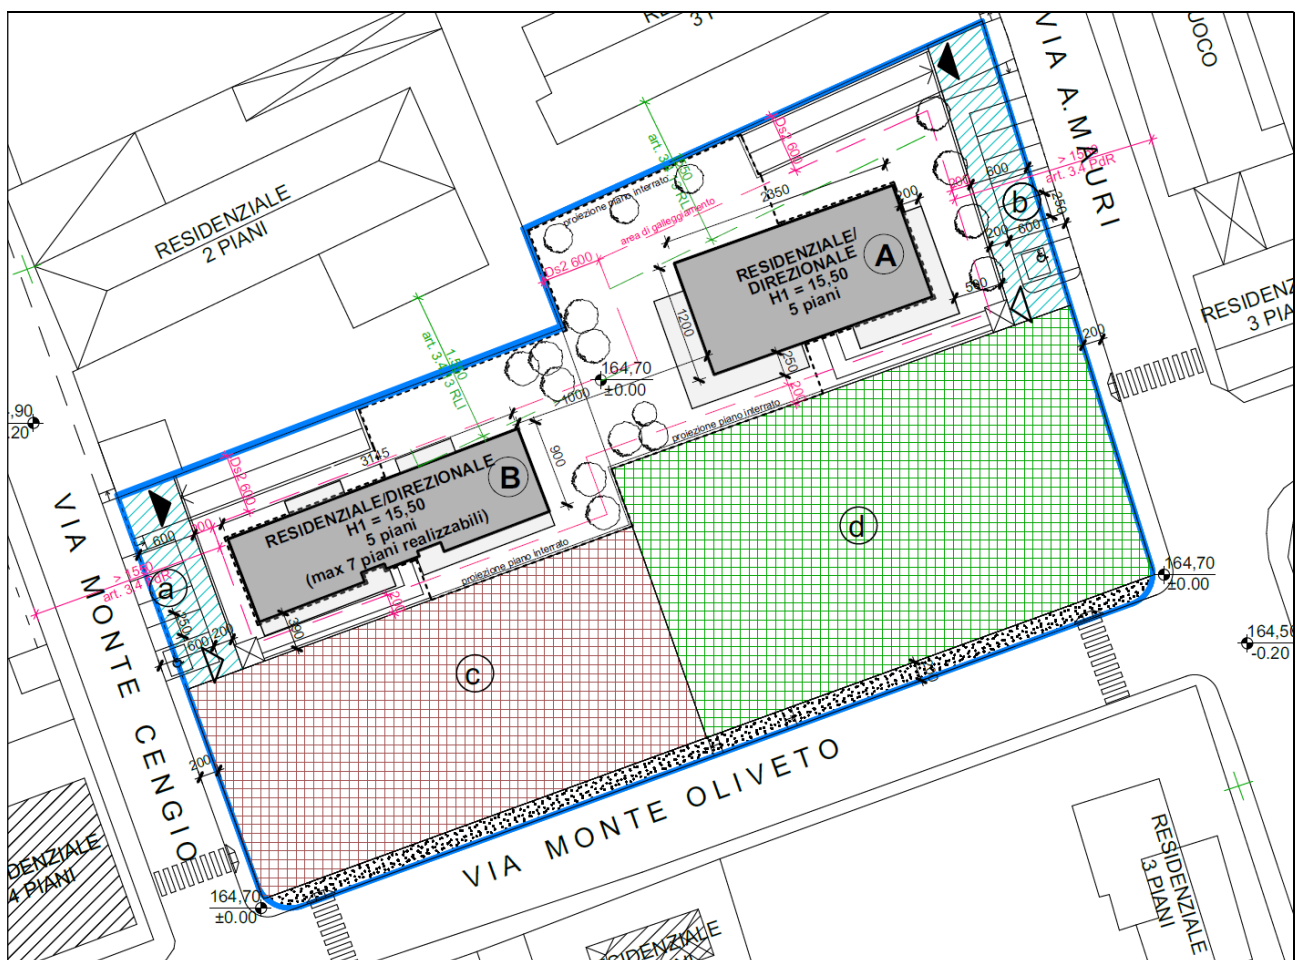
planimetria Piano Attuativo Monte Oliveto
